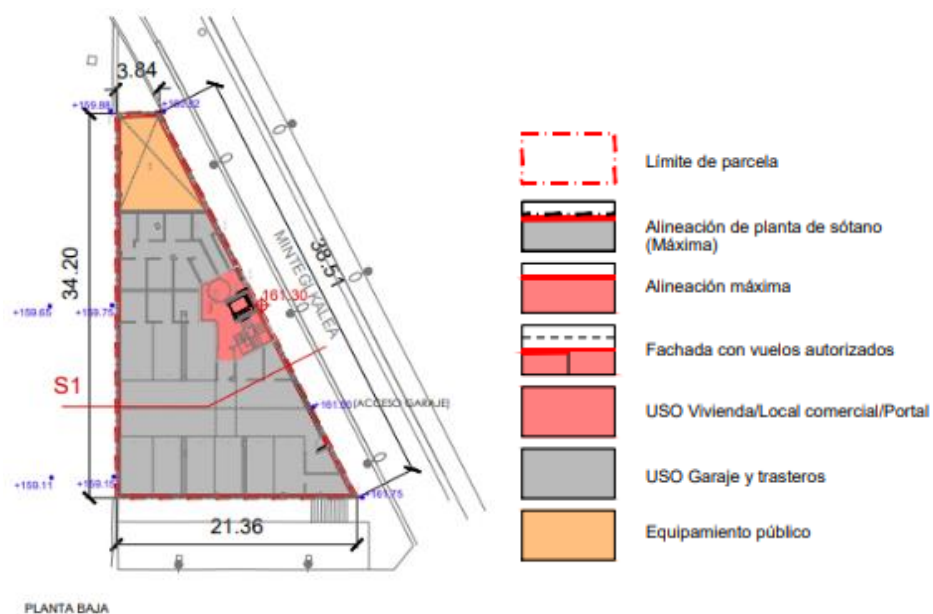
Condiciones de edificación de la parcela propuesta para la planta baja
